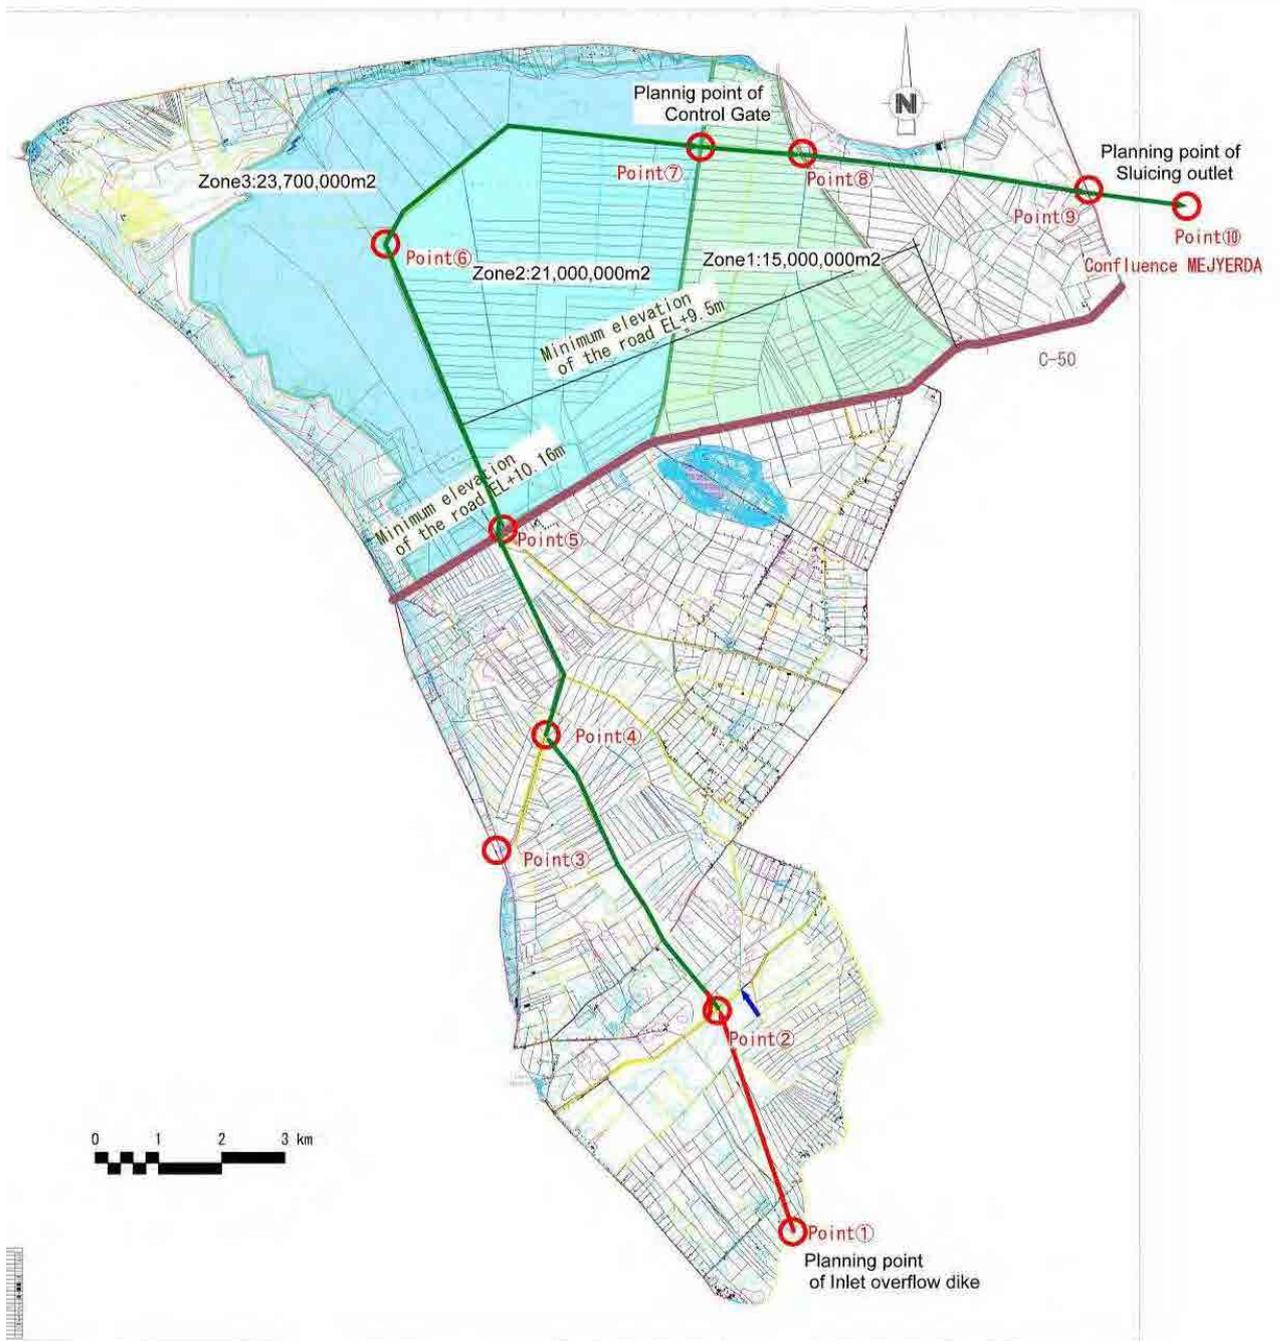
Plan du projet de bassin de retardement d'El Mabtouh
